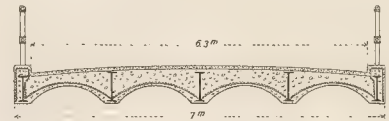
und 3. Straßenbrücke aus Beton und Eisen.
